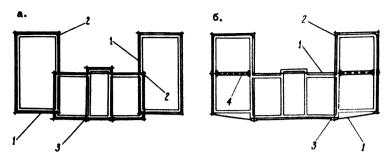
Схема расположения тяжей в здании сложной фигурании в плане:
